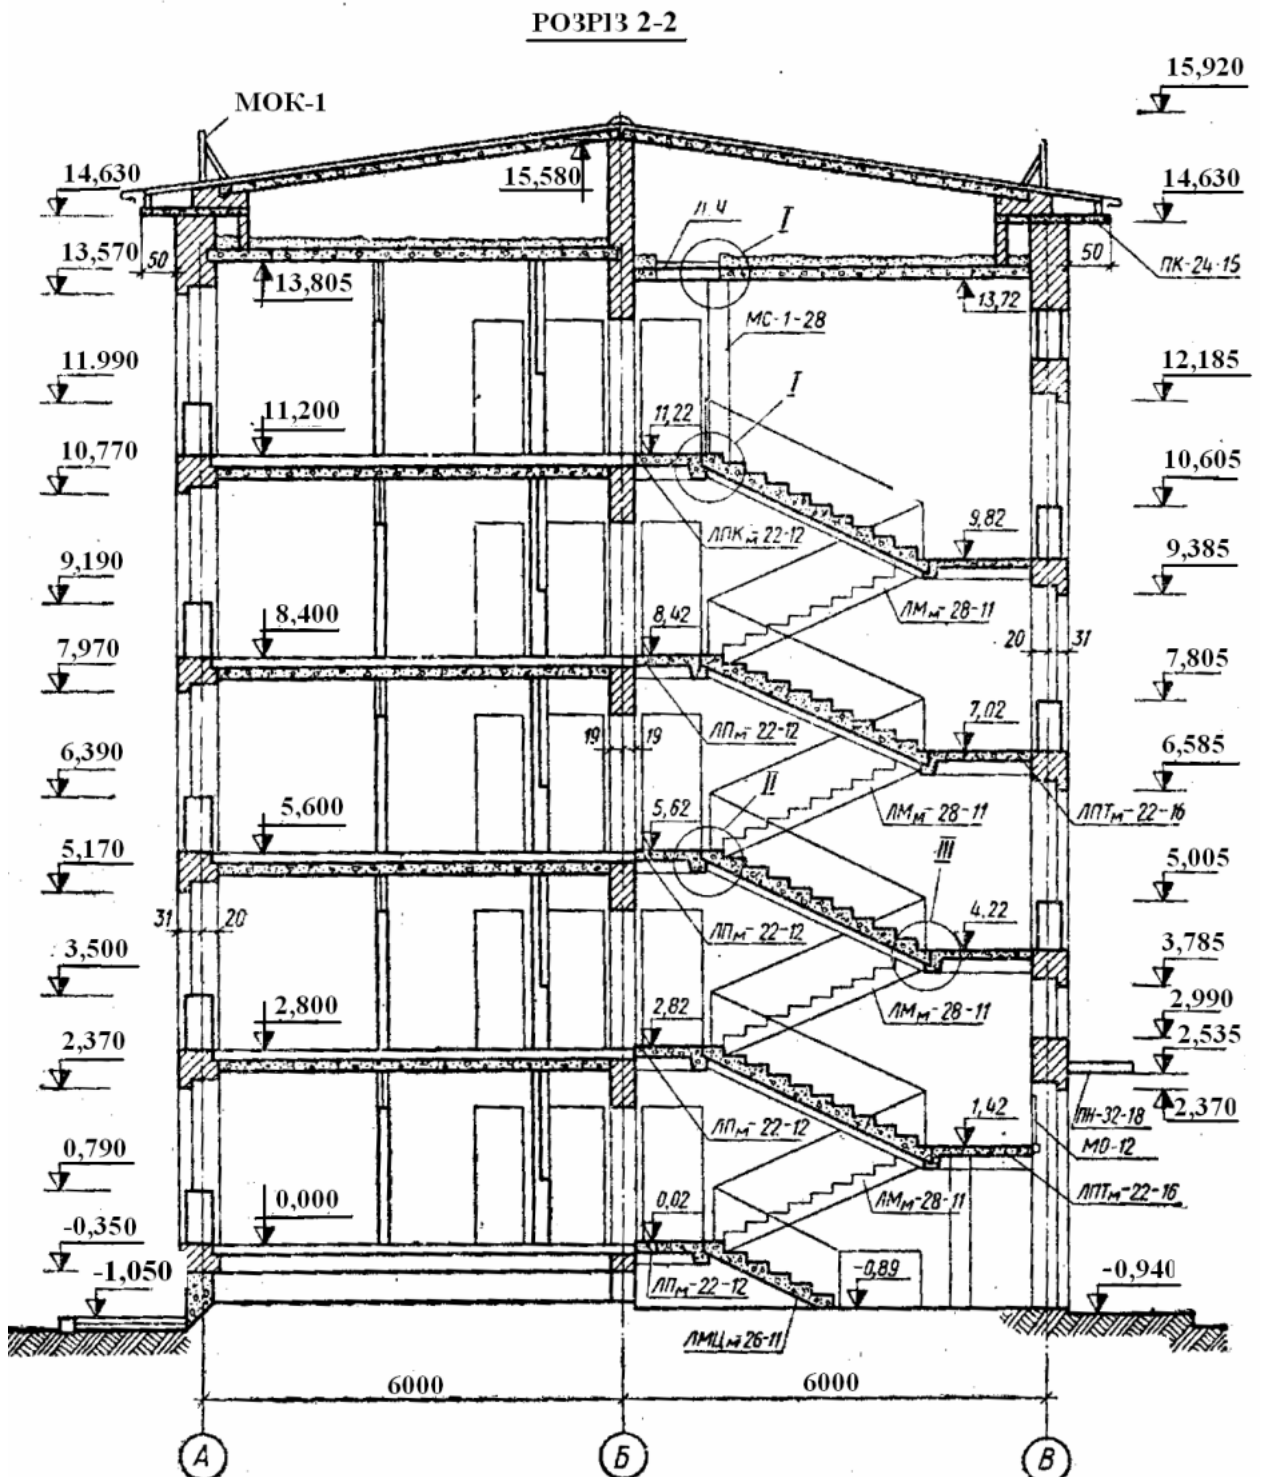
Розріз по сходах п'ятиповерхового житлового будинку із цегляними стінами. Сходи залізобетонні крупноелементні
